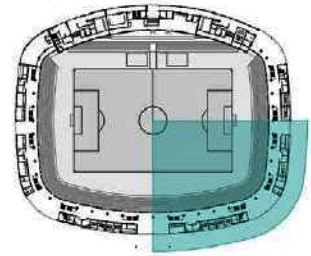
Ampliaciones planta baja Fuente: Elaboración propia
